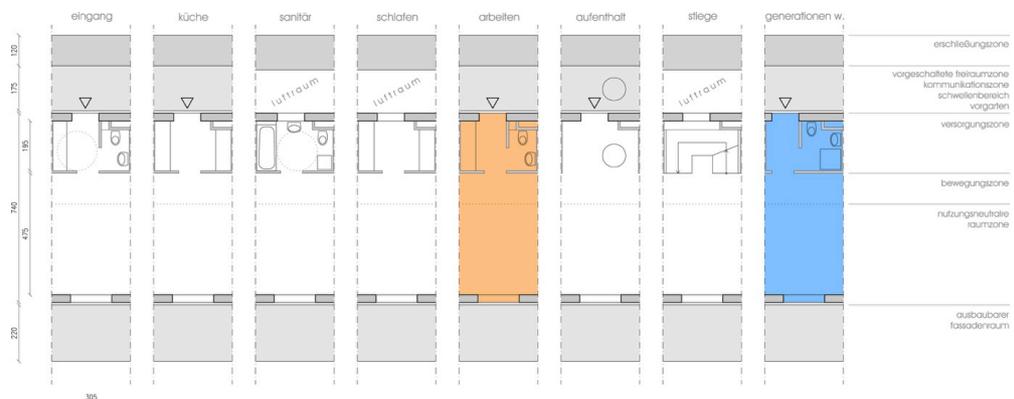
Wohnbaupilotprojekt, Sandgasse „Future Housing“ Graz, Professor Hansjörg Tschom, Grundrissmodule
